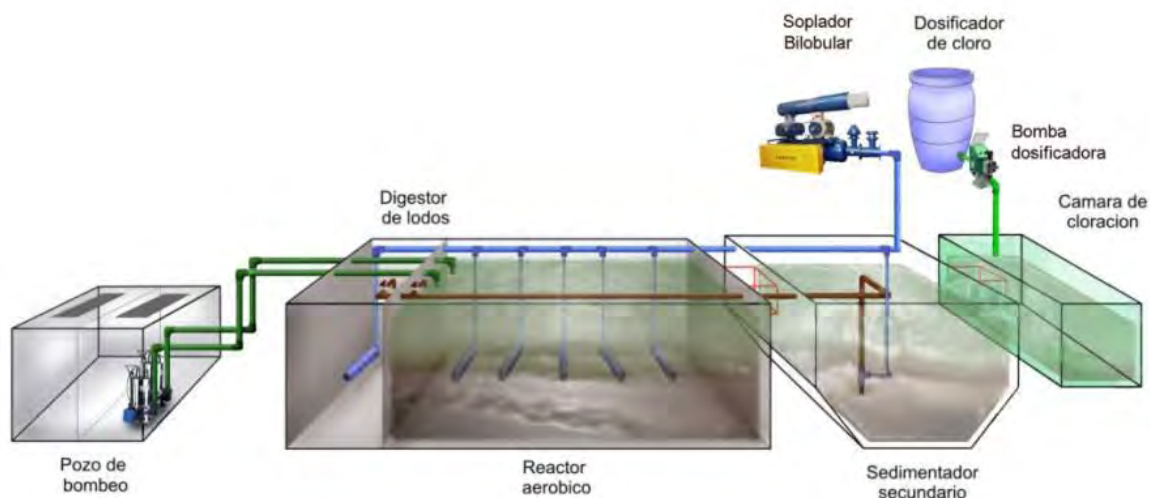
Esquema de la planta de tratamiento por lodos activados
